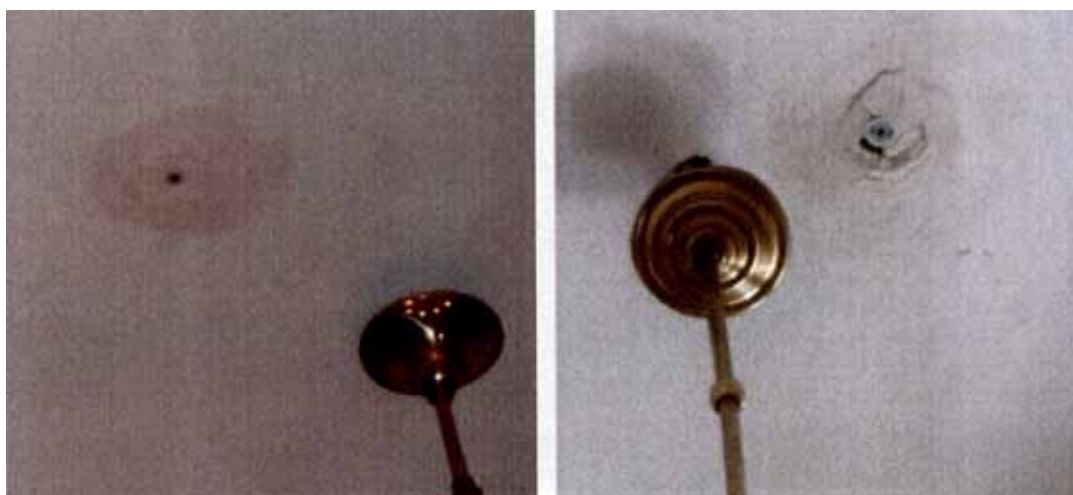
Průchod stropem potrubí systému nasávací detekce kouře umístěného v půdních prostorech státního zámku Mníšek pod Brdy.
